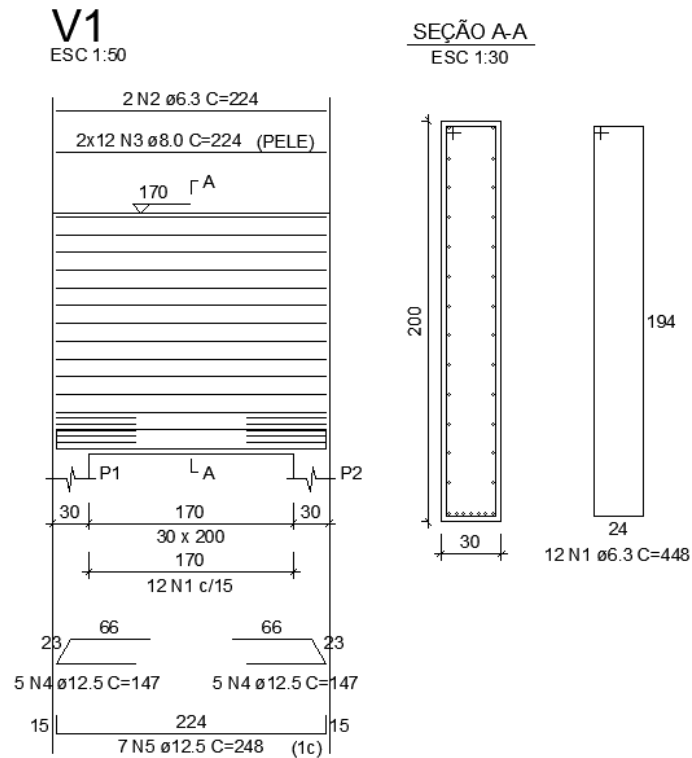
Viga modelada no Eberick – Detalhamento da viga.
